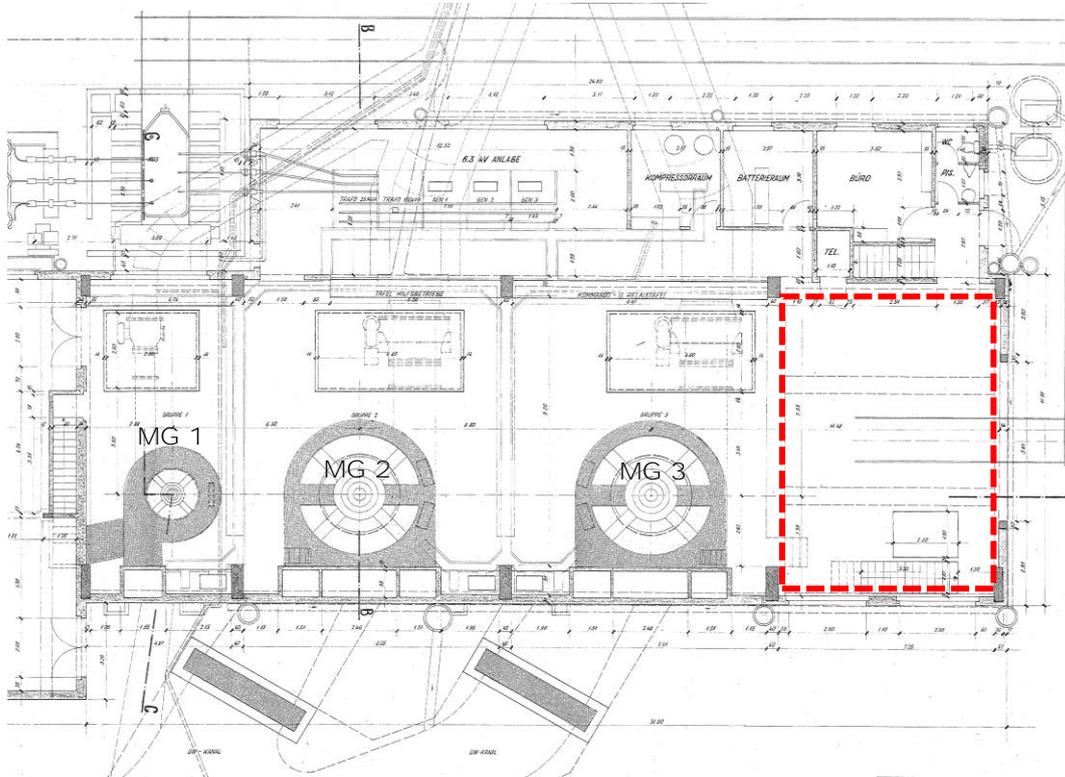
Grundriss des Maschinensaals mit rot eingerahmtem Umschlagplatz (Ausschnitt aus Plan 1_812).
